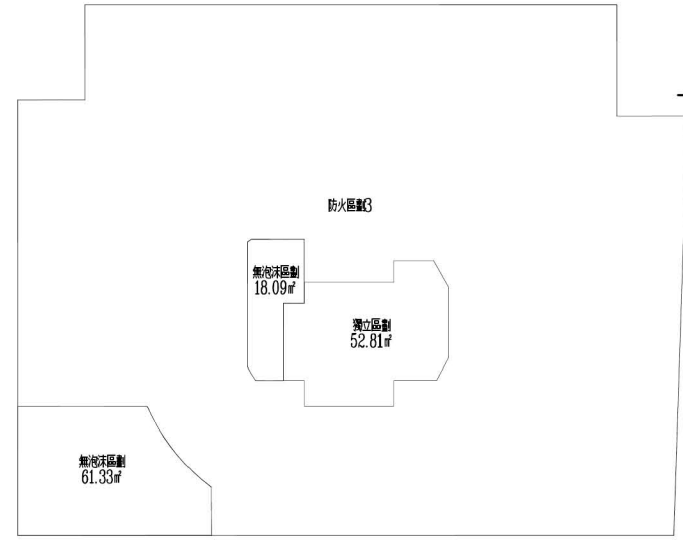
地下 2 層平面圖 (比例尺 1/200)
